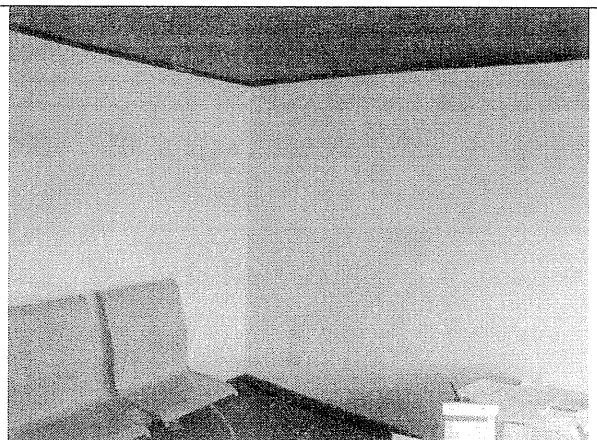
Fisuras en muro del costado norte, segundo piso.
